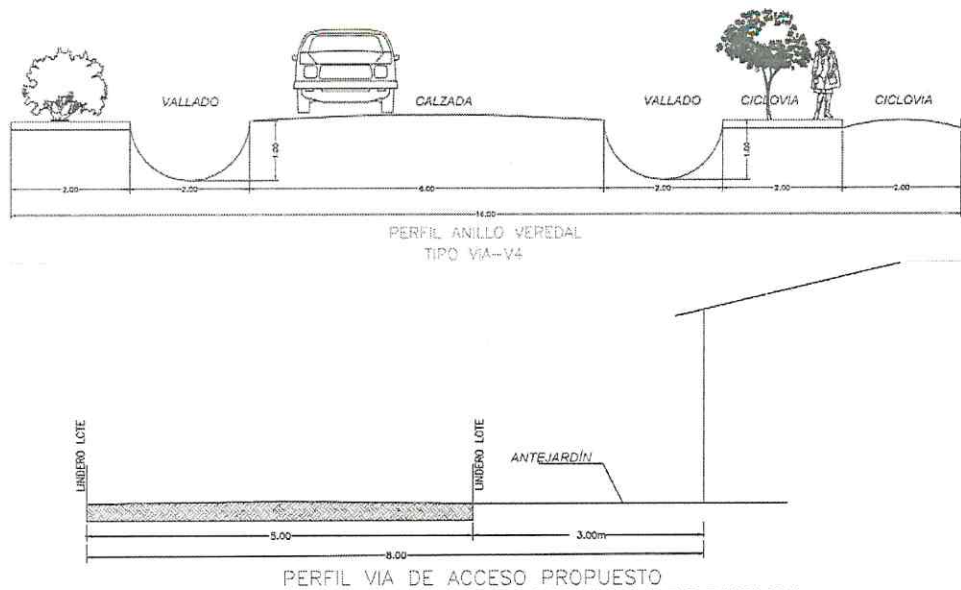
Perfil vial propuesto SERVIDUMBRE PUBLICA
